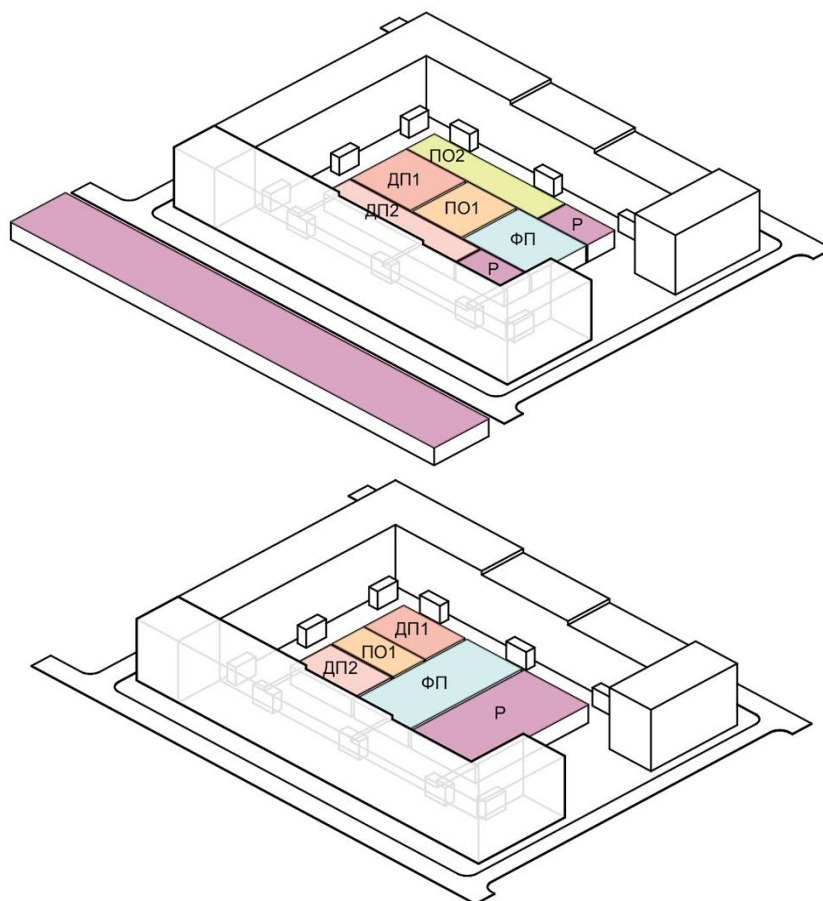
Примеры размещения функциональных зон во дворе квартальной застройки.
